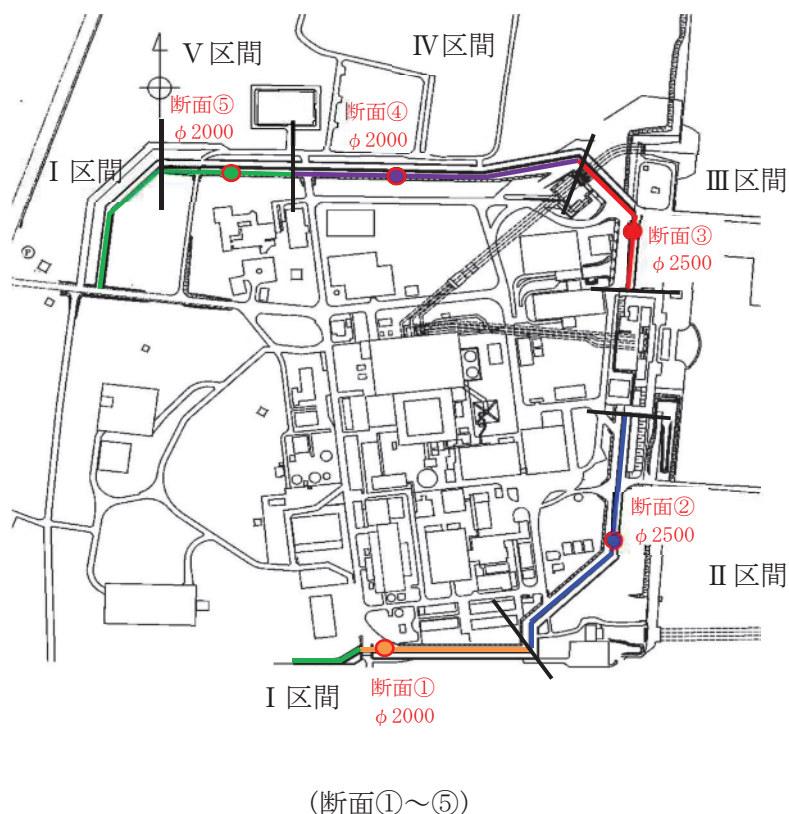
防潮堤（鋼管杭鉄筋コンクリート防潮壁）の照査位置図
